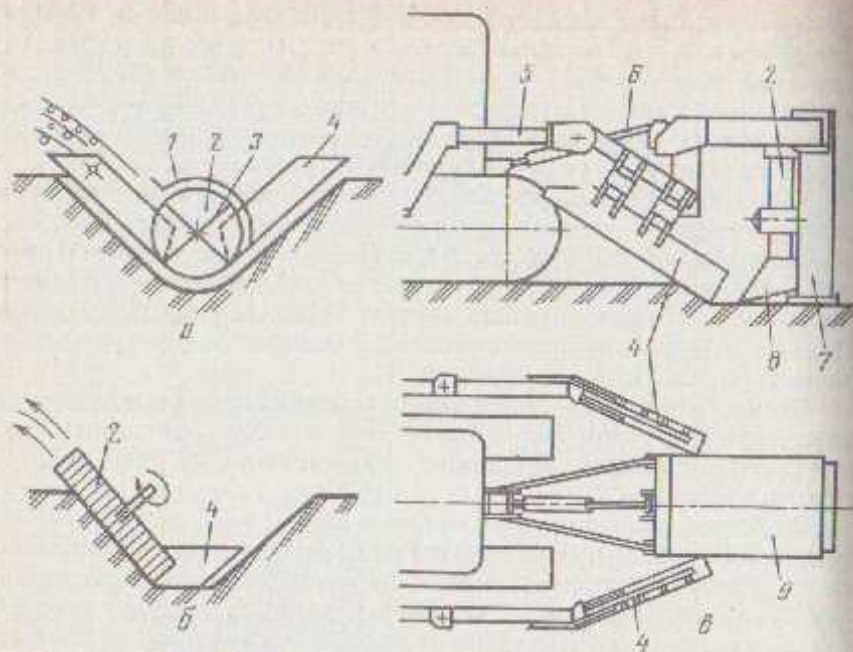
Схемы комбинированных рабочих органов канадоочистителей: а — полнопрофильный; б — частичнопрофильный; в — устройство рабочего органа внутри канального очистителя; 1 — кожух фрезы; 2 и 3 — фрезы; 4 — кож-долька; 5 и 6 — подъемная и продольная тяги.
